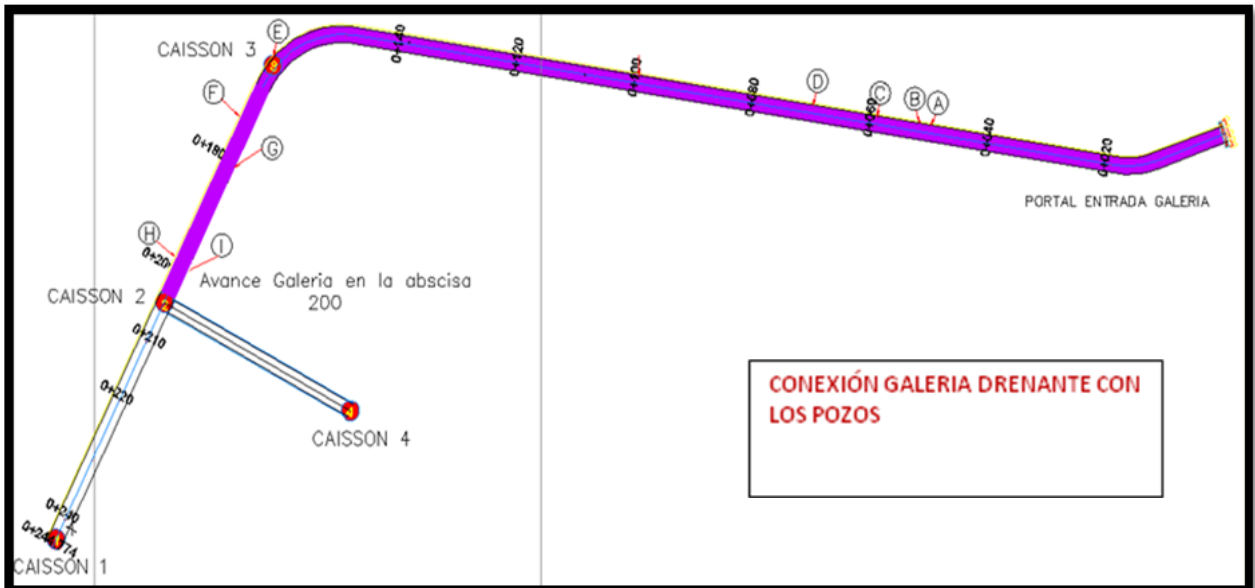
Localización eje de la galería y conexión con los pozos (caissons) de abatimiento.
